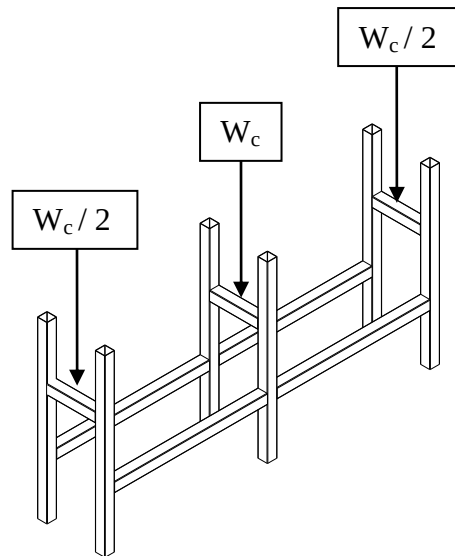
Distribución de las cargas sobre las vigas. Fuente. Propia.
